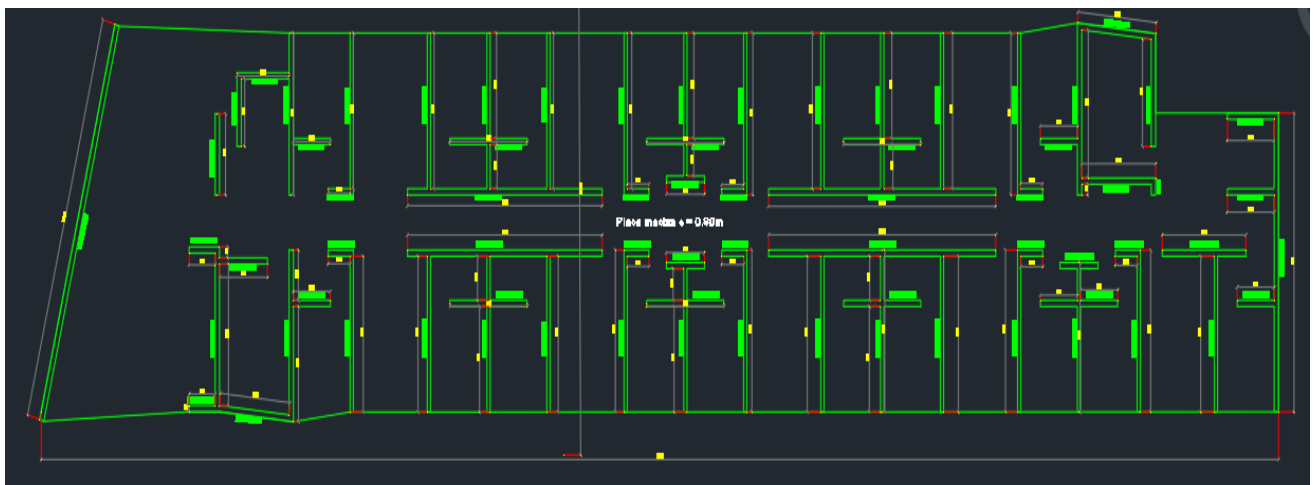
Diseño de losa y muros en AutoCAD 3D
